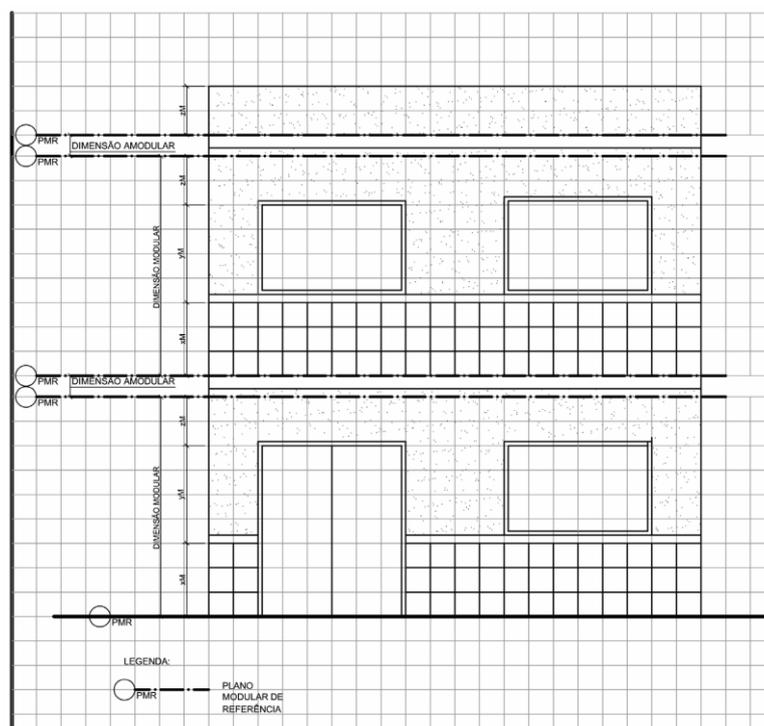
Modulação da alvenaria e aplicação de espaço amodular para o conjunto laje, contrapiso e piso. Malha 30x30cm. Fonte: Amorim, Kapp e Eksterman, 2010, a, p. 17.
